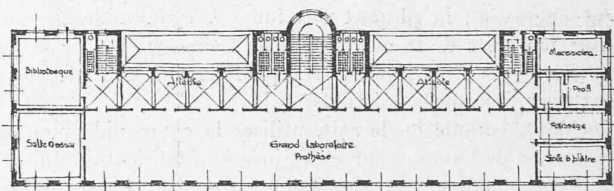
Plan du 2^e étage. — 1 : 800.
